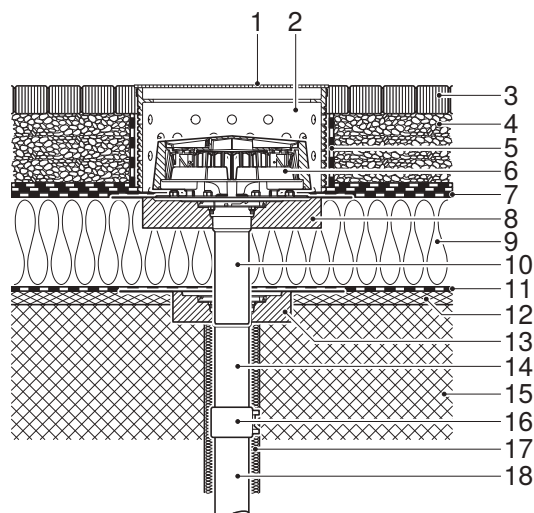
Montage dans toiture massive isolée avec pare-vapeur et revêtement d'étanchéité, praticable
